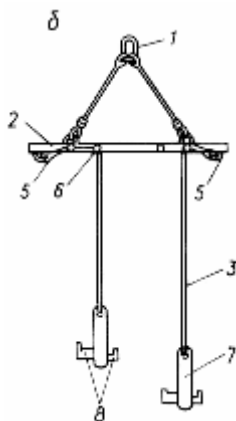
Устройства для погрузки барабанов с кабелем:
